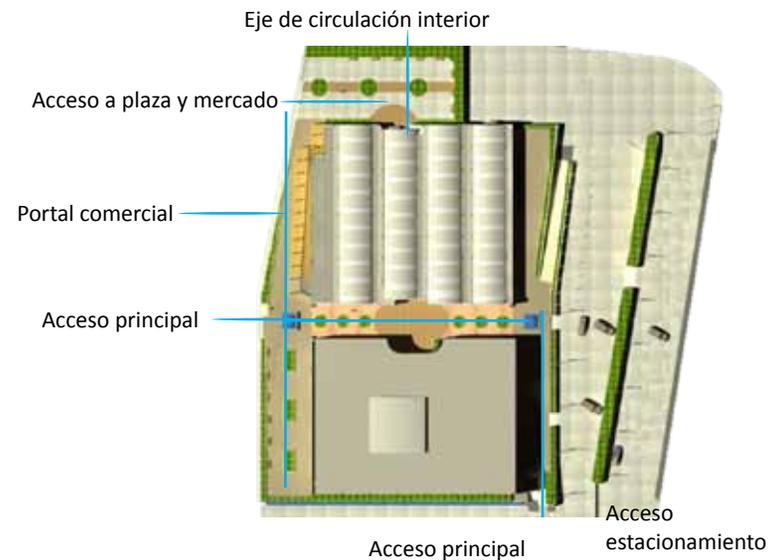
Planta de conjunto con pasillos áreas de circulación. Fuente: (LALV Febrero, 2011)
